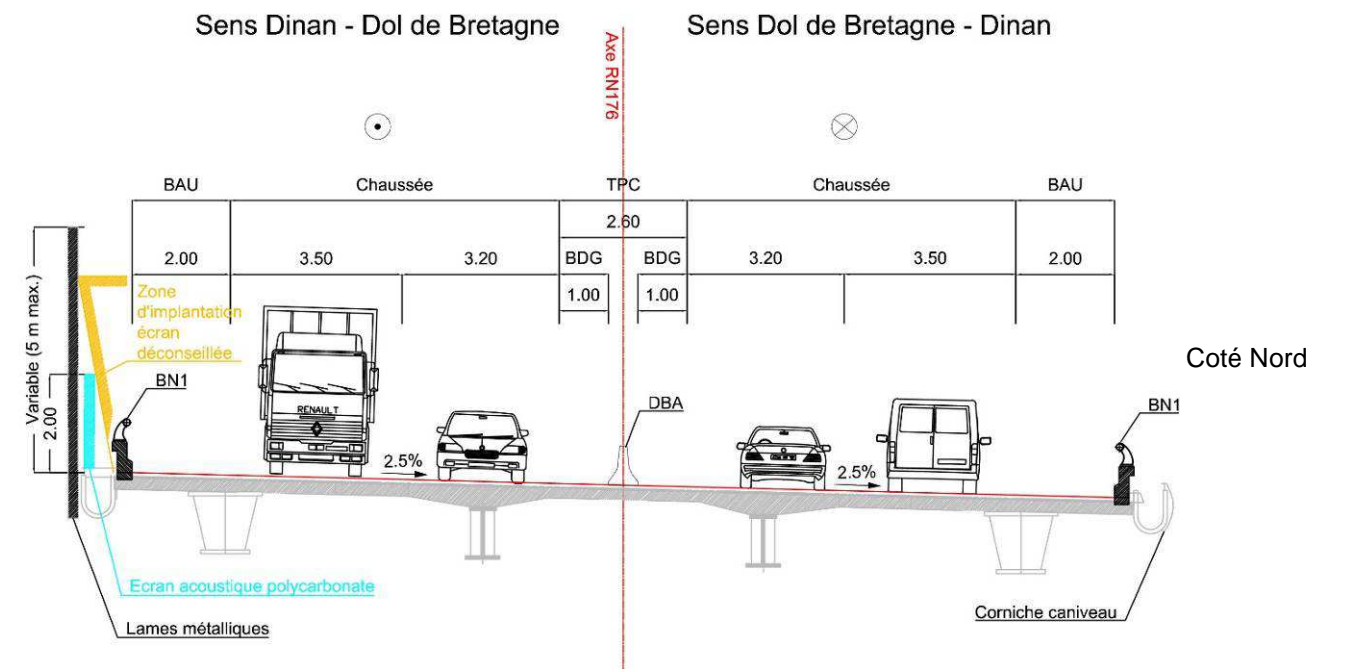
Le profil en travers de la voie et l'implantation réglementaire du mur anti-bruit (source ARCADIS - CEREMA)
